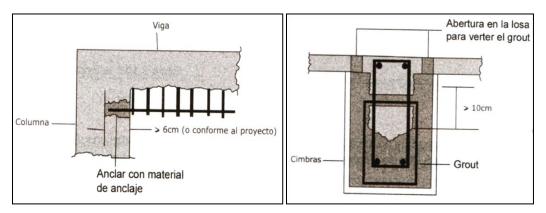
Detalles constructivos de la solución utilizado en el método refuerzo con recrecido de viga ó columna. Fuente: Libros de Rehabilitación y mantenimiento de estructuras en concreto, Paulo Helene, Brasil
